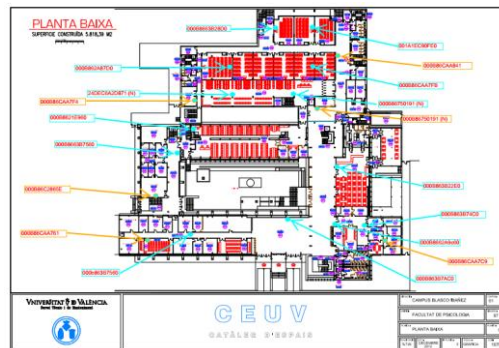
Ubicación de los puntos de acceso en la planta baja de la Facultad de Psicología
